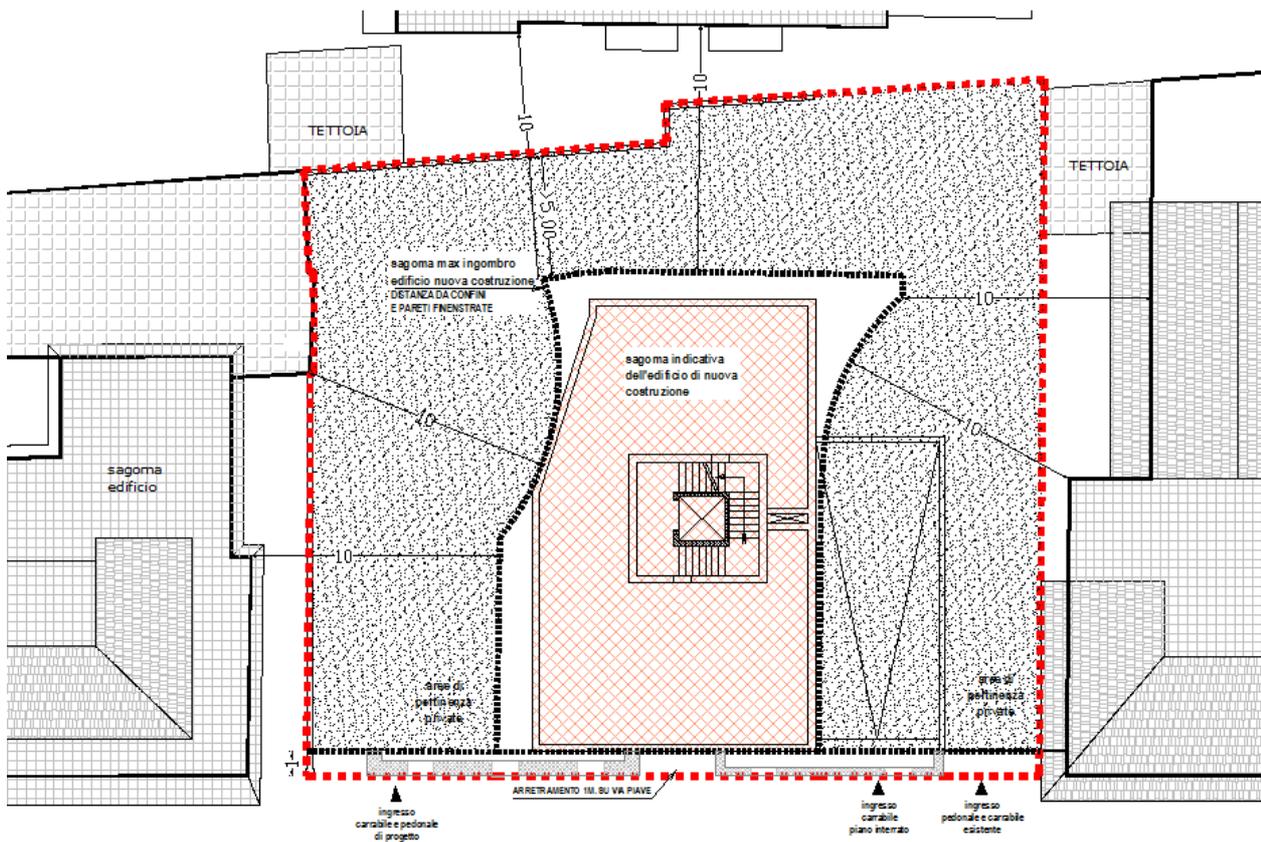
planimetria con indicazione delle distanze minime dai confini e dai fabbricati
